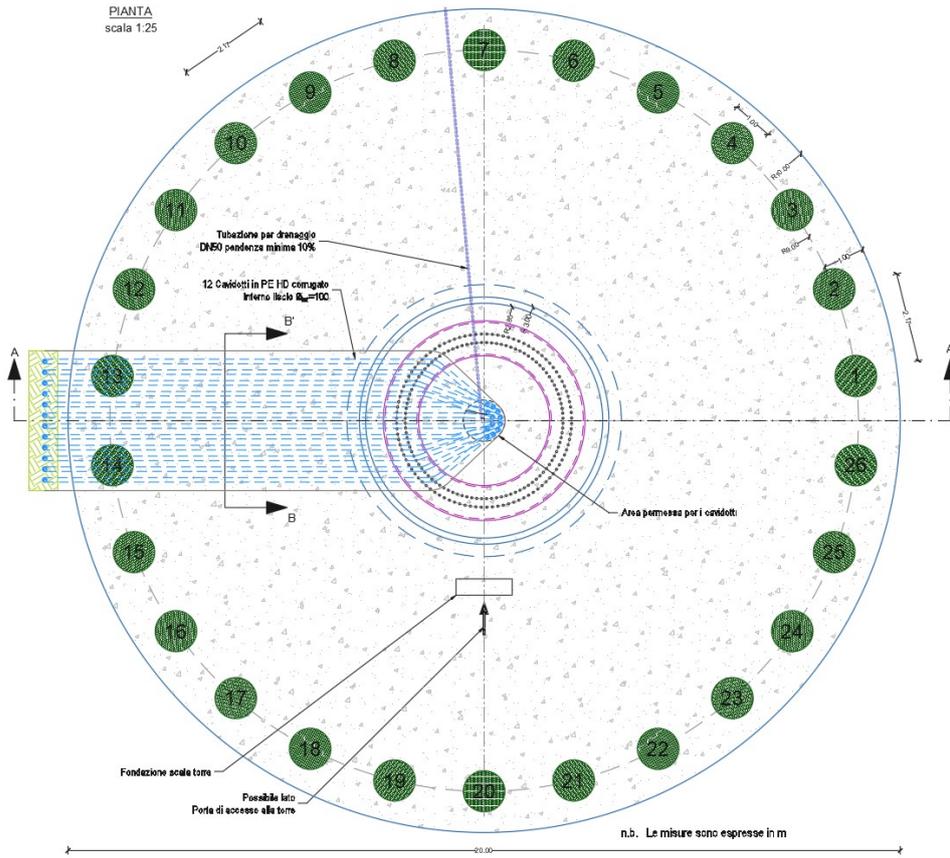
Pianta del plinto con indicazione dei pali di fondazione (n.26 del diametro 1000mm)
